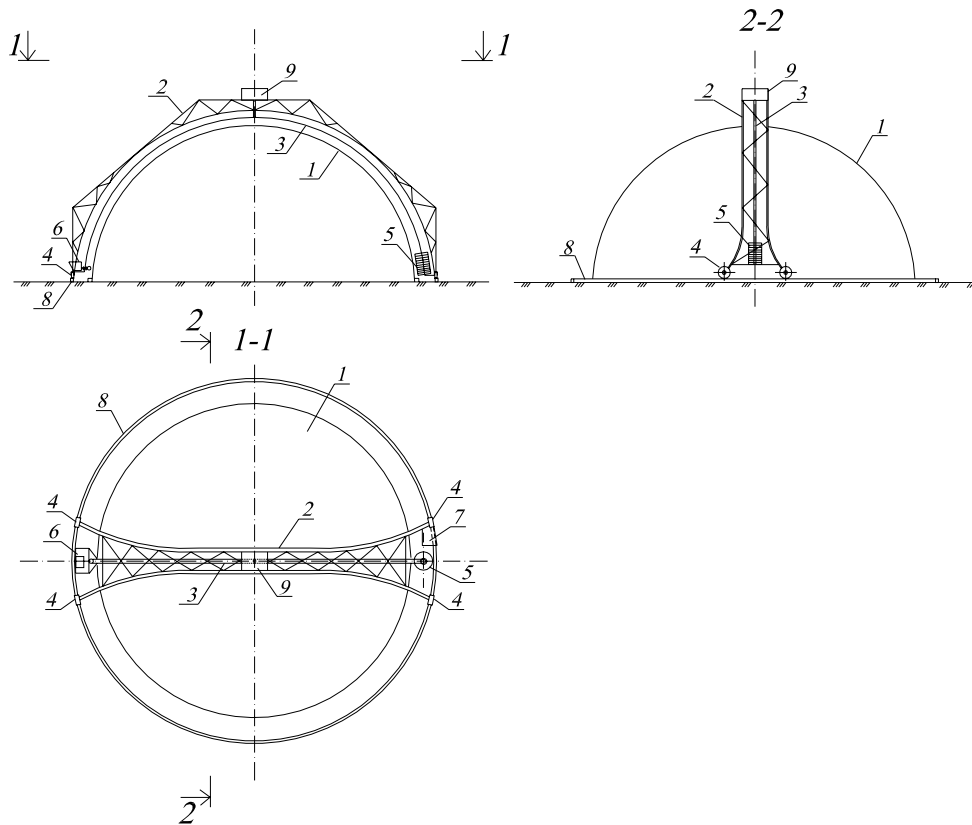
Монтаж арочной опалубочной системы: 1 – опалубка купола; 2 – несущая арка; 3 – направляющая; 4 – ролики; 5 – арматурная бухта; 6 – торкрет-установка; 7 – механизм вращения несущей арки; 8 – роликовые пути; 9 – механизм подъема.
